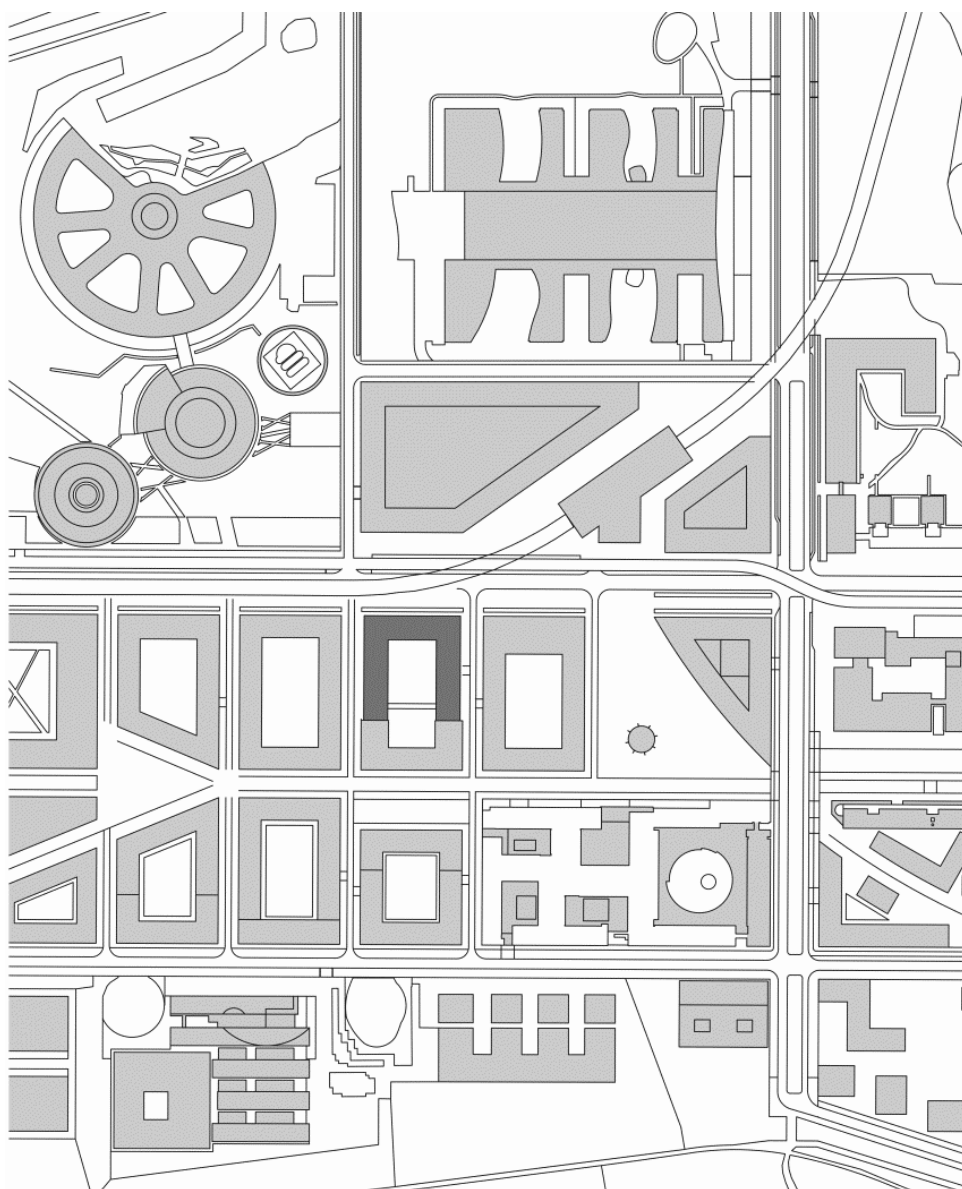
Planta de situação na quadra e entorno imediato. Estudo de caso em destaque, em cinza-escuro. Fonte: TRIBILLON, 2022. Disponível em: <https://www.architectural-review.com/buildings/student-housing-in-paris-saclay-by-bruther-and-baukunst>Acesso em: 28/01/2024.
